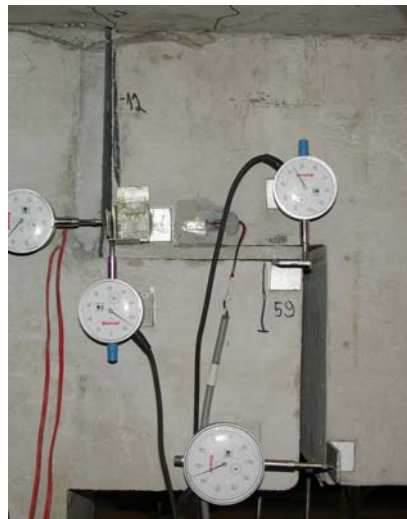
Fissura vertical entre o dente gerber e o graute de preenchimento.
